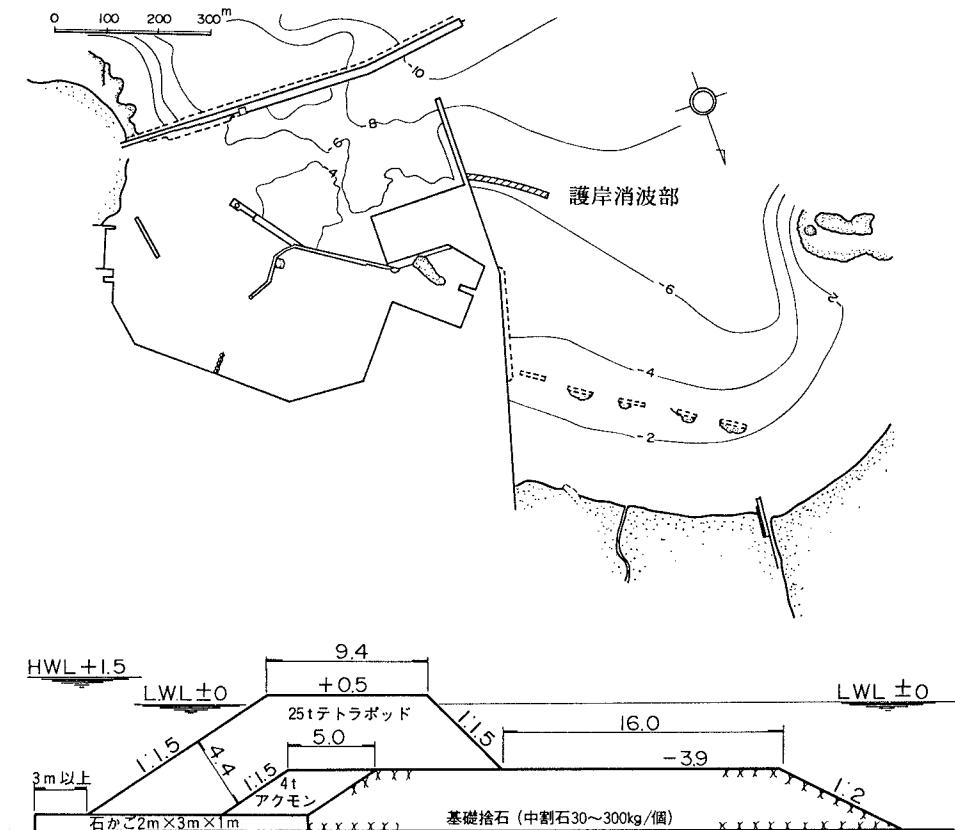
様似漁港の平面図及び低天端傾斜堤の断面図
